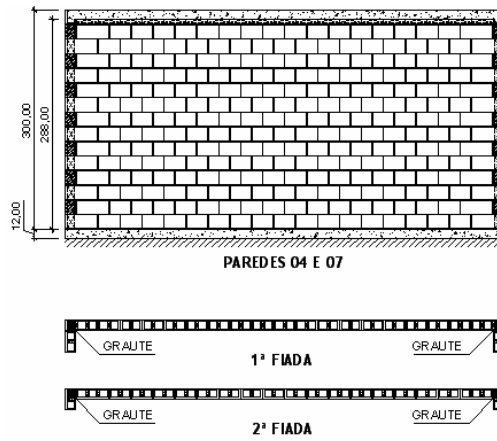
Paredes 04 e 07 – Detalhe da 1ª e 2ª fiadas e elevação.
